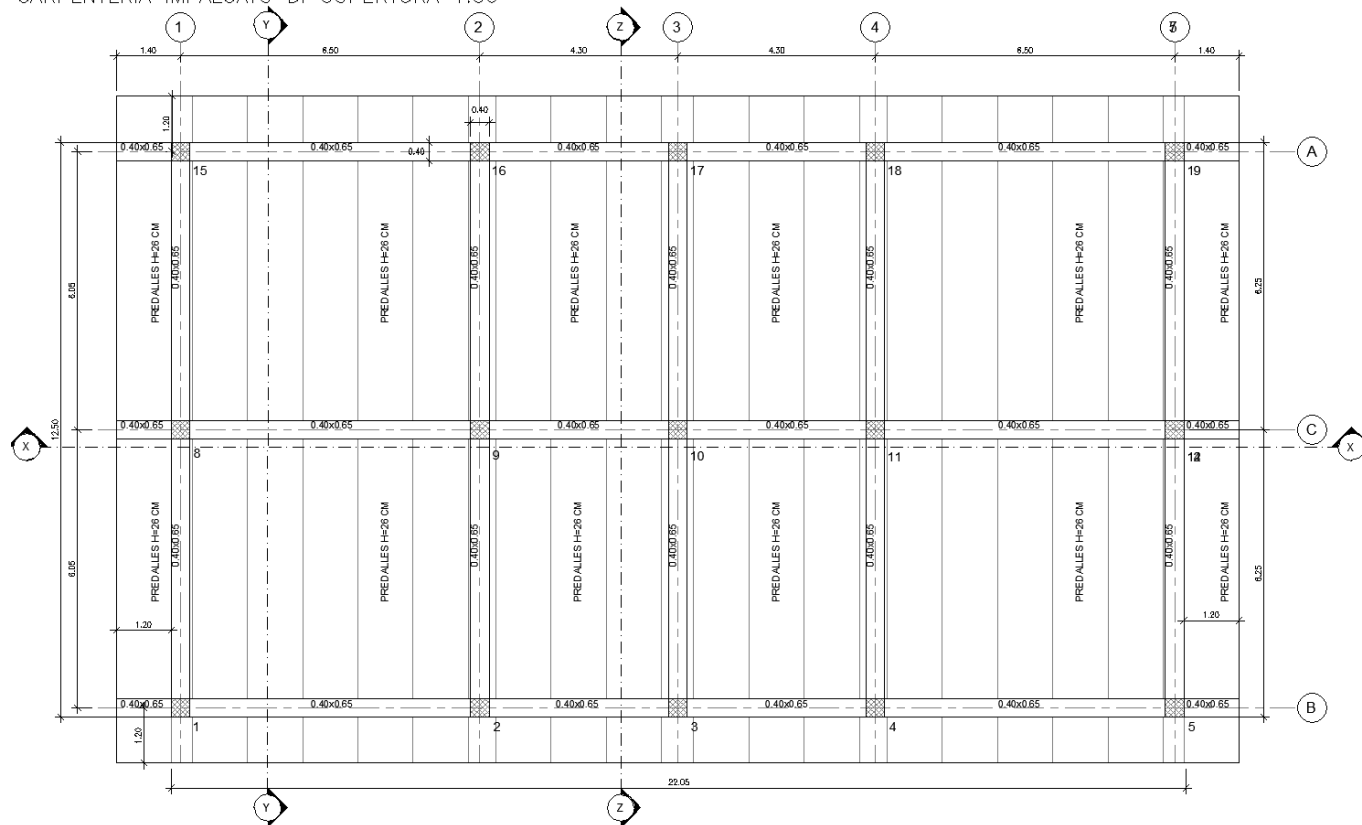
Struttura intelaiata del fabbricato in pianta
